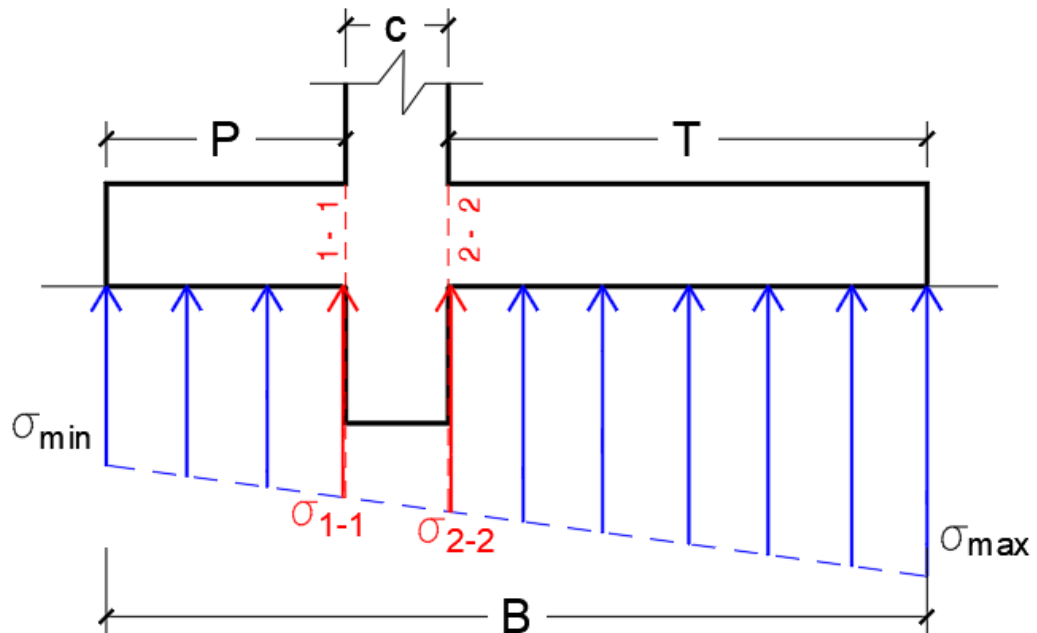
Esquema de esfuerzos en las secciones crítica, Fuente: Autor
